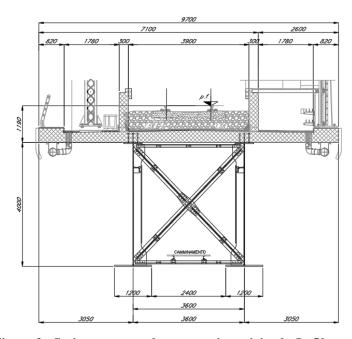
Sezione trasversale campate in acciaio-cls L=50 m
